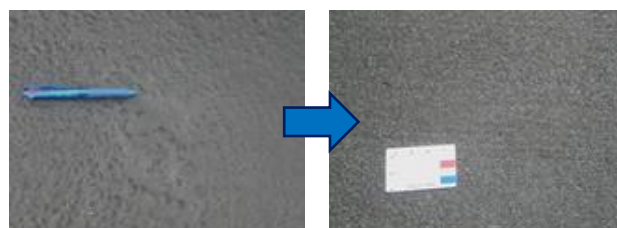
施工直後と供用開始 6 ヶ月後の路面状況
